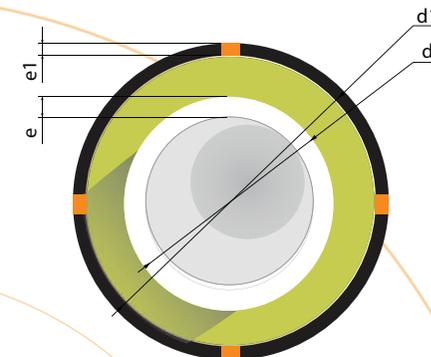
Размеры труб ИЗОЛА-Т95
